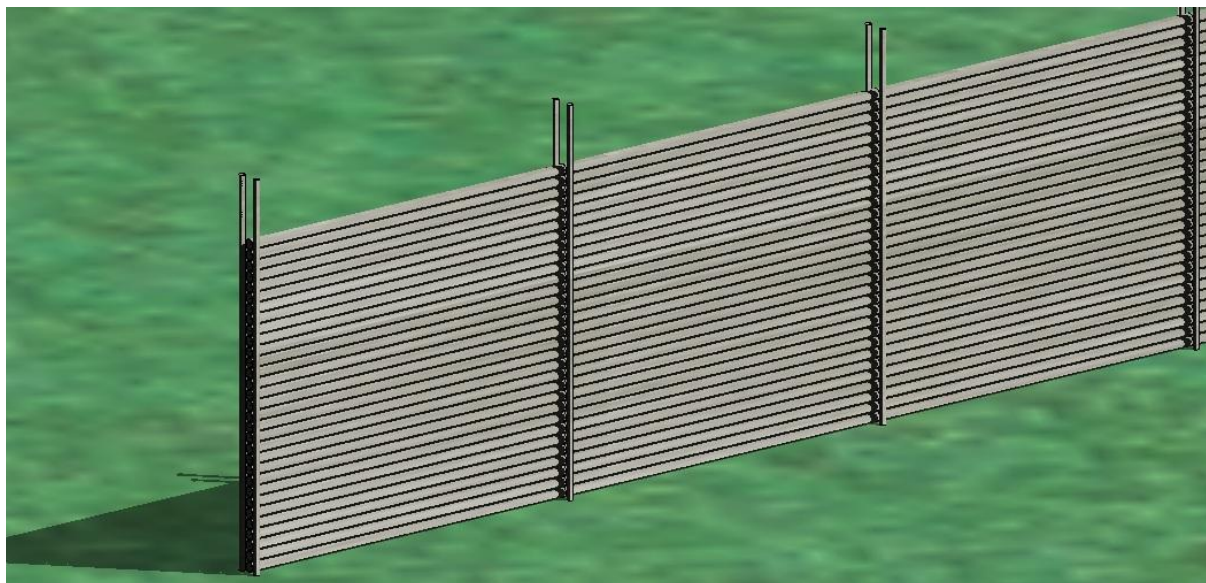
Esquema pormenorizado da primeira camada de tubos.
